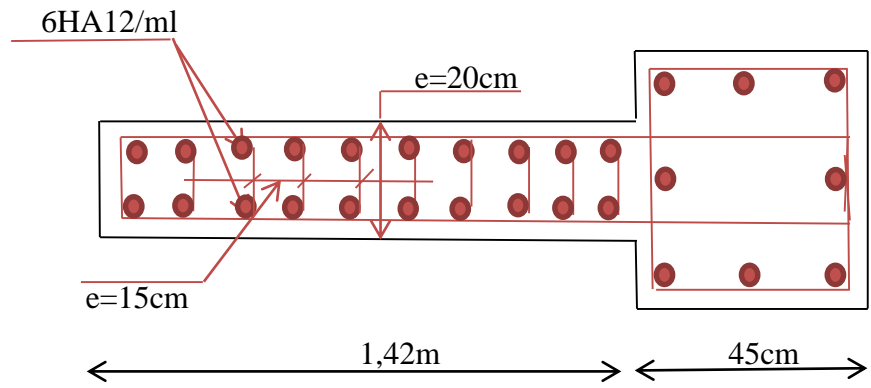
Coupe horizontale de ferrailage des voiles(VL3) ou niveau RDC
